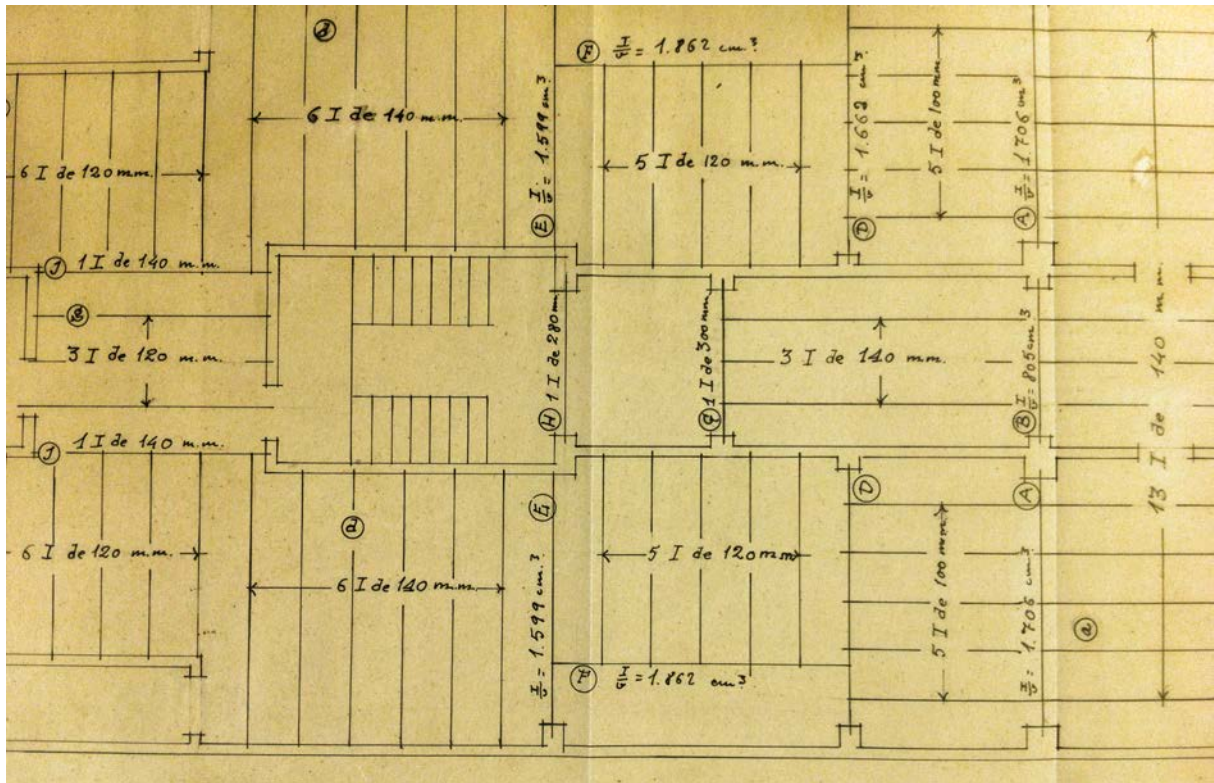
Detall de plànol d'estructures de la planta baixa (casa Joaquin Boada, de Pere Benavent, 1926). Font: AHCOAC H109A/2/30.
